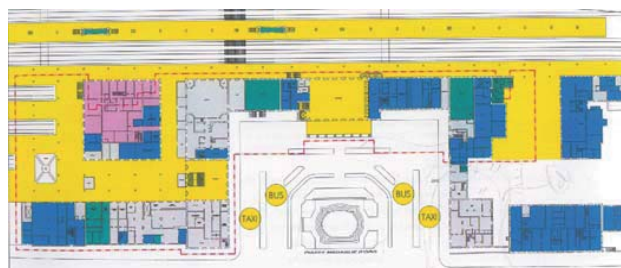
Stazione "storica" di Bologna Centrale: planimetria
